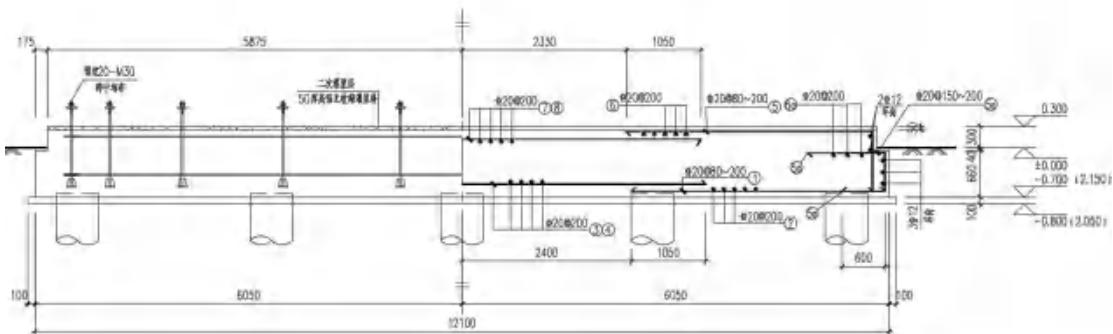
原料罐组、产品罐组 A 基础断面图
